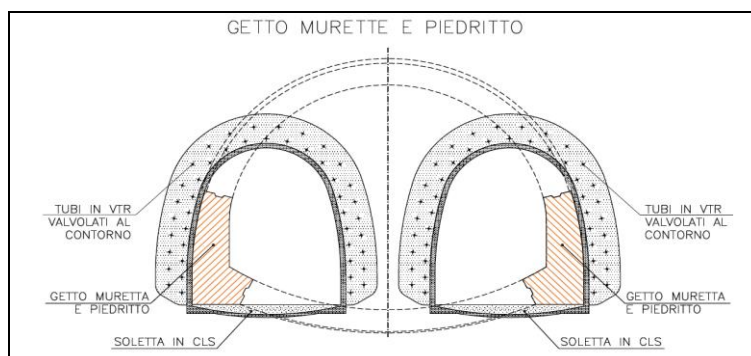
Getto delle murette e dei piedritti di cunicolo
